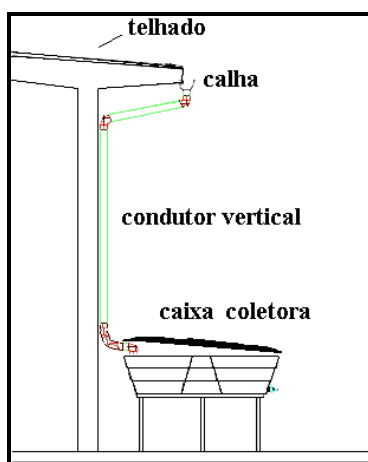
Sistema de captação de água pluvial utilizado no trabalho.
